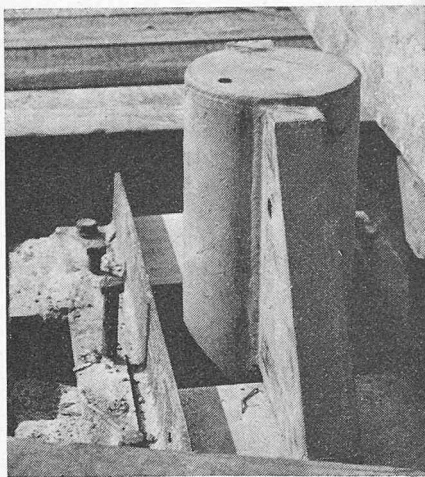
Hängesäule mit 219 mm Durchmesser am Kopfende mit angeschweissten Schneiden, abgestützt auf zwei Stahllagerplatten
